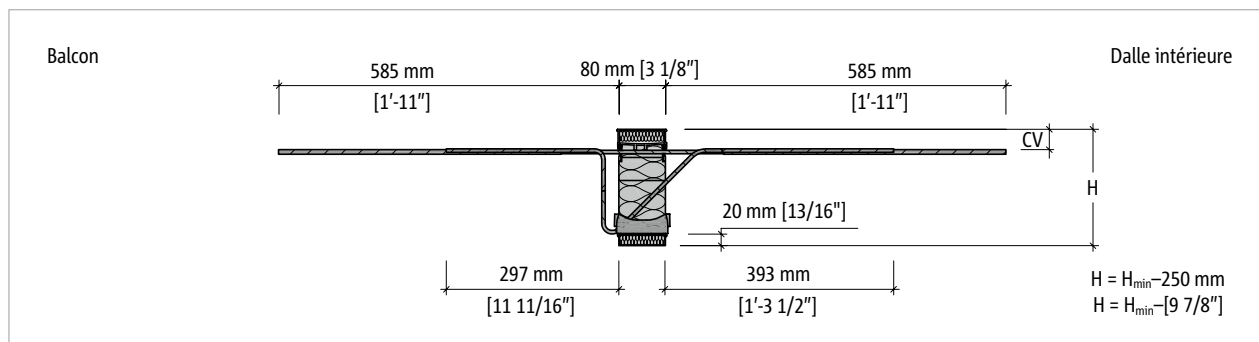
Schöck Isokorb® T Type CK-M1-V1 à M6-V1 : coupe transversale du produit
